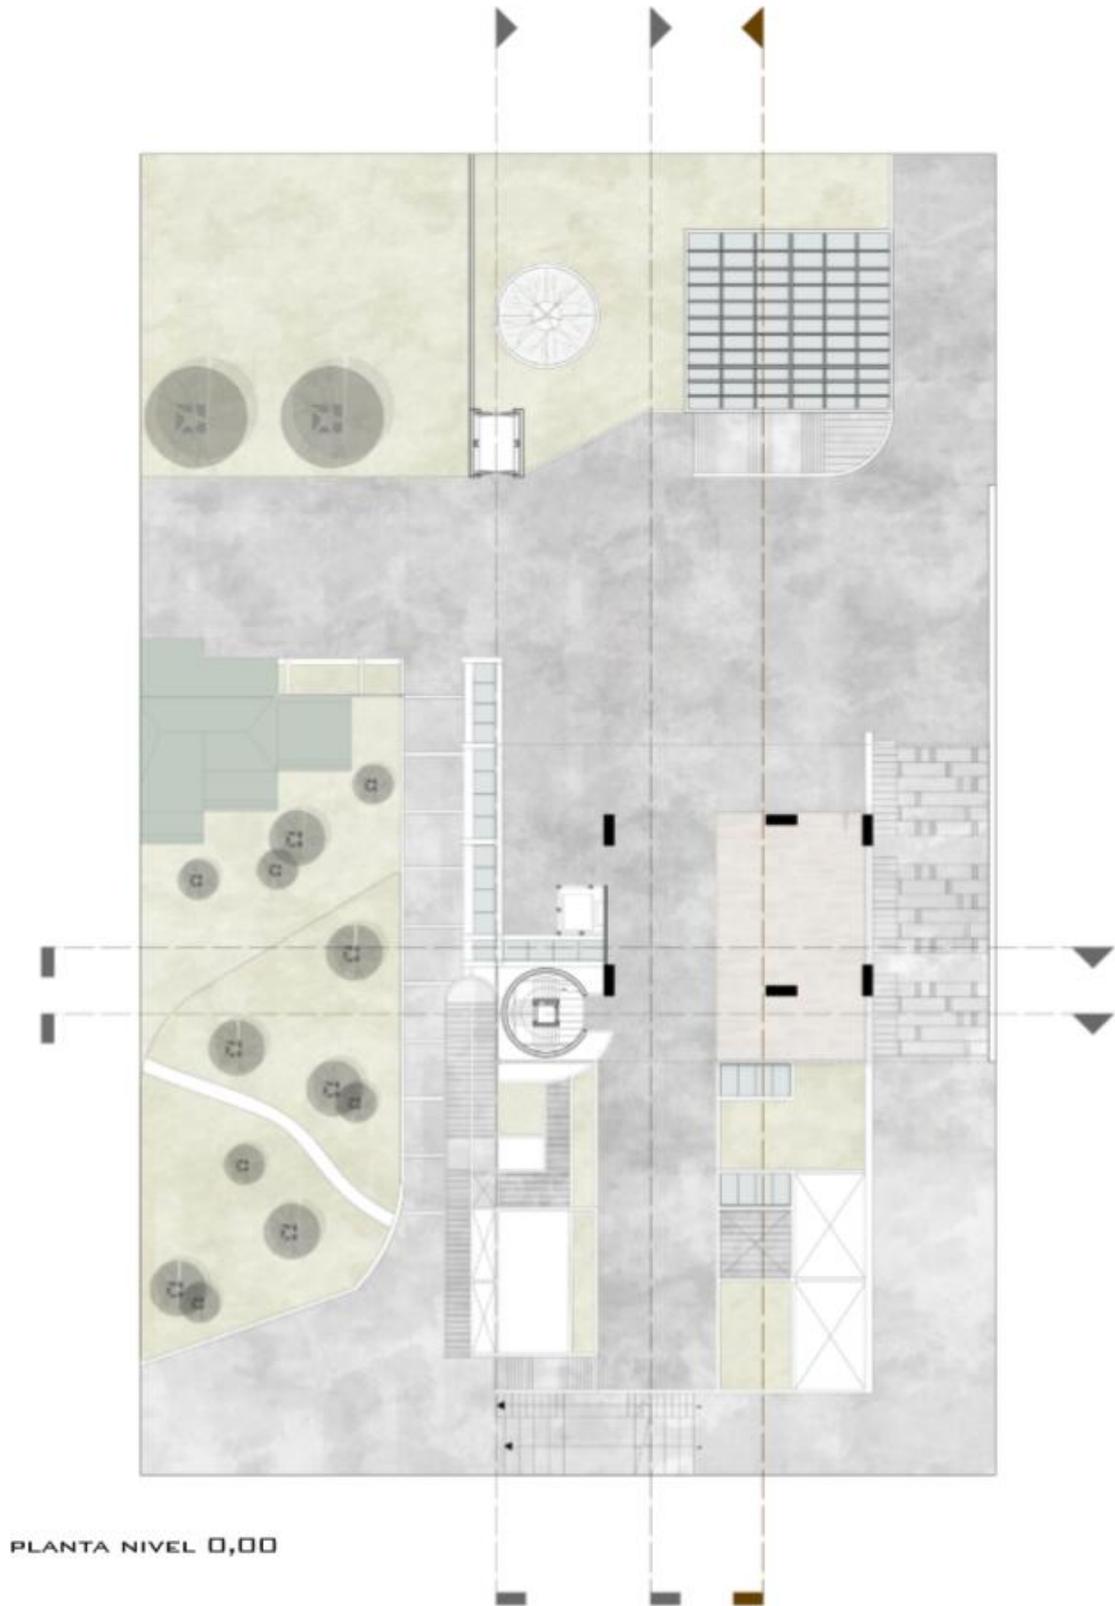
Planta baja, nivel 0.00 (Elemento propio).
